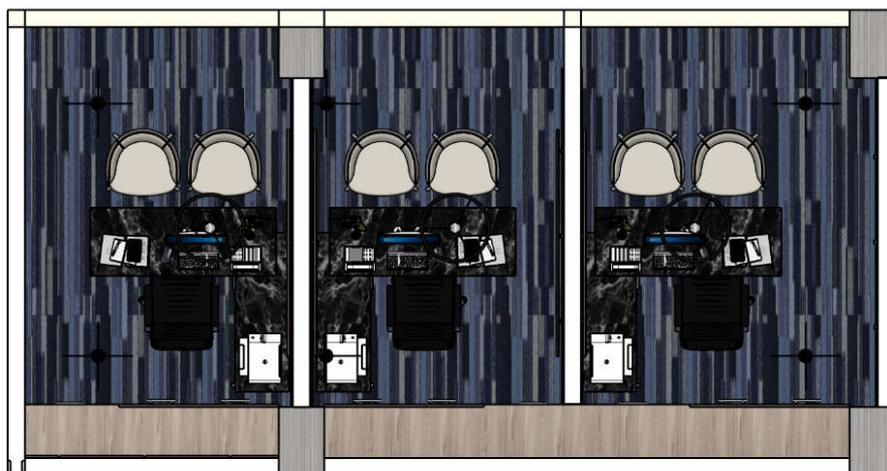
19 Ruang Sekretaris & Ruang Tunggu Gedung I BPOM
